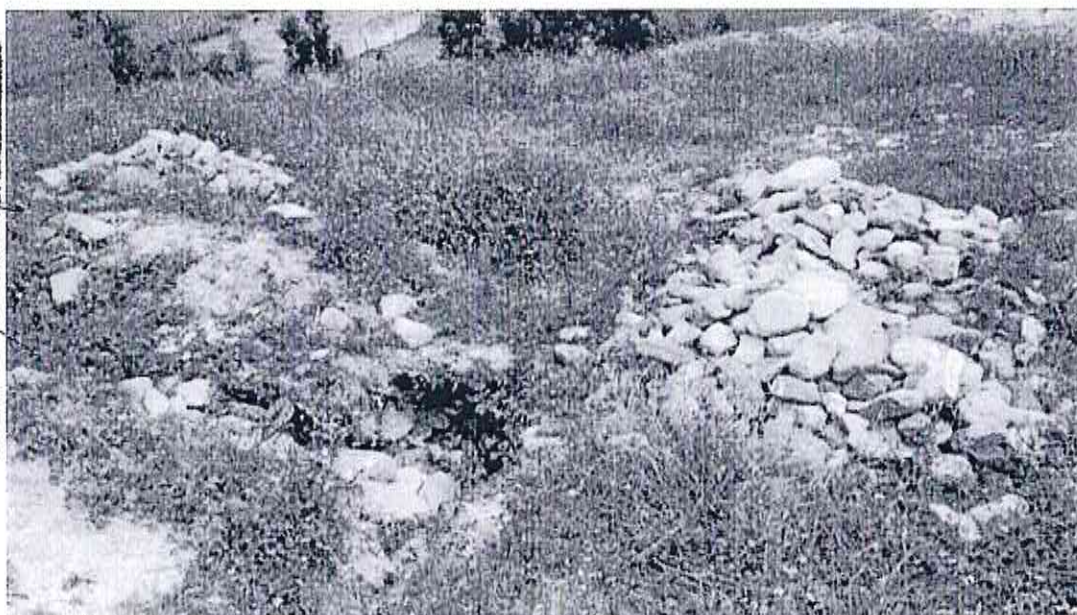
Área con zanjas para construcción de bases para muros sector "B"
